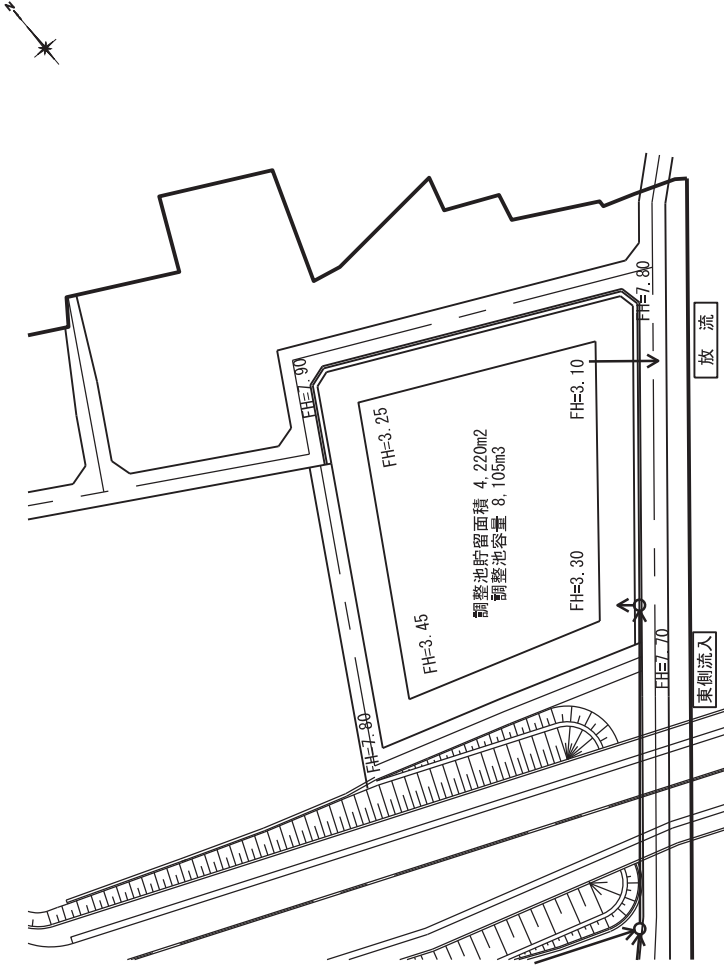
(2) 調整池計画平面・断面図 (第2調整池)
